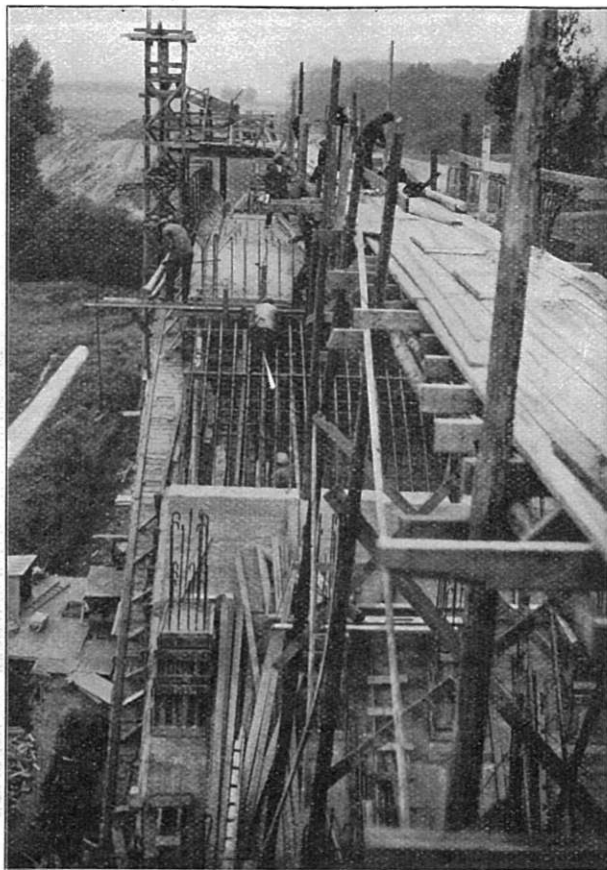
Viaduc de la Pède. — Installation de chantier.
